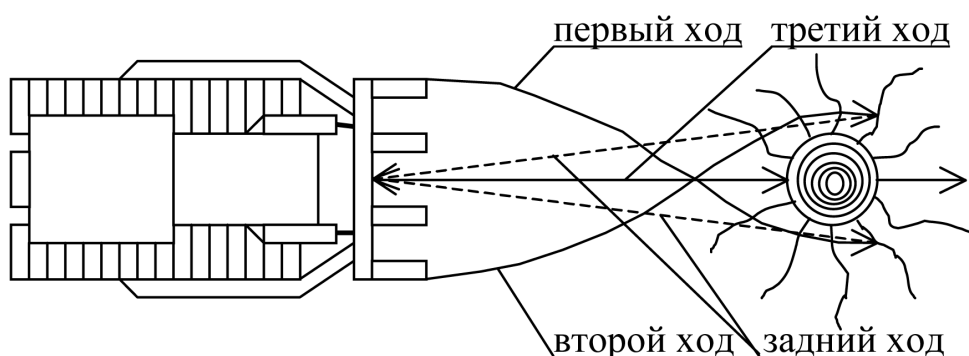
Схема движения корчевателя при корчевании крупных пней
